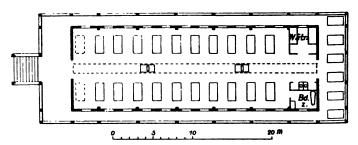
b. Charité-Baracke, Grundriss.
